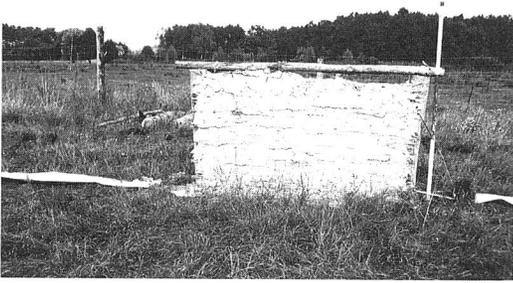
Klein Körös, Wandsegment, Versuchsaufbau mit Messvorrichtungen vor dem Brand.
